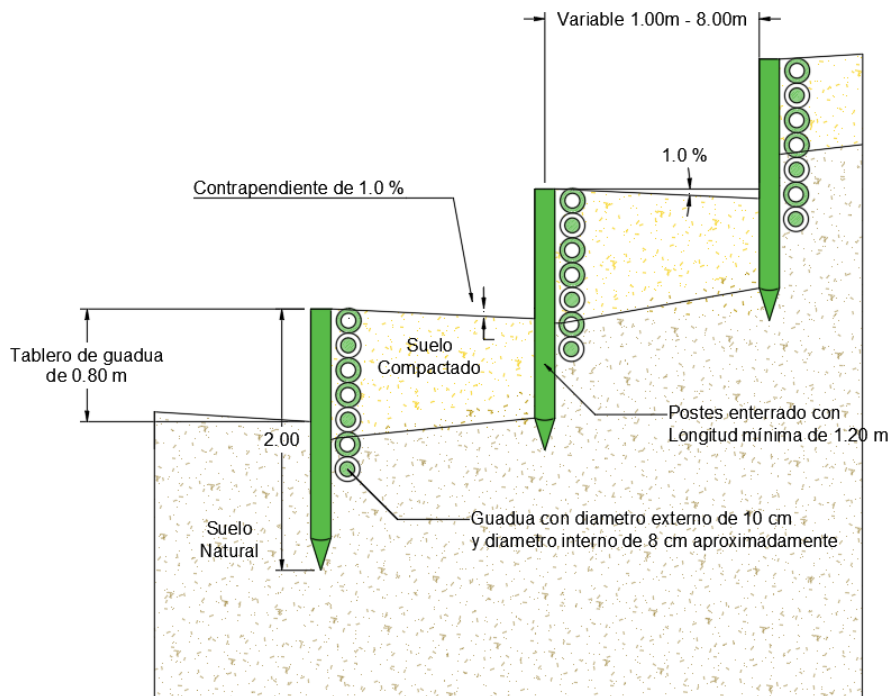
Detalle de los trinchos (Vista de perfil)
